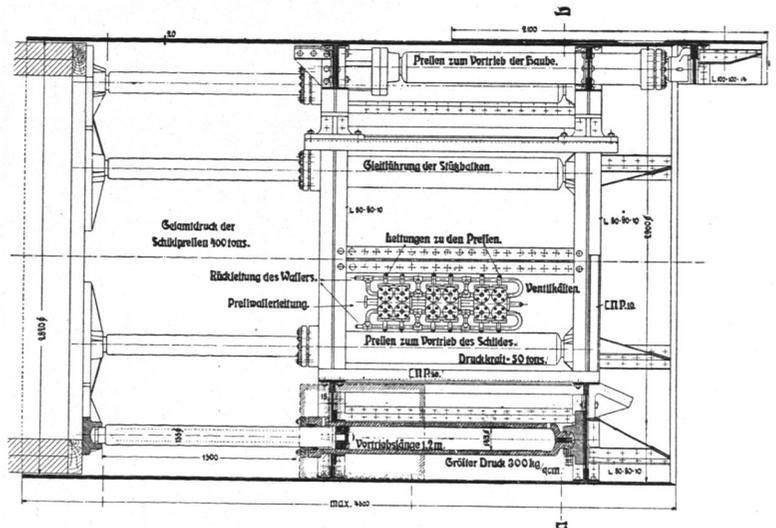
Tunnelstrecke der Bürgerweide, Brustschild, Längenschnitt.
